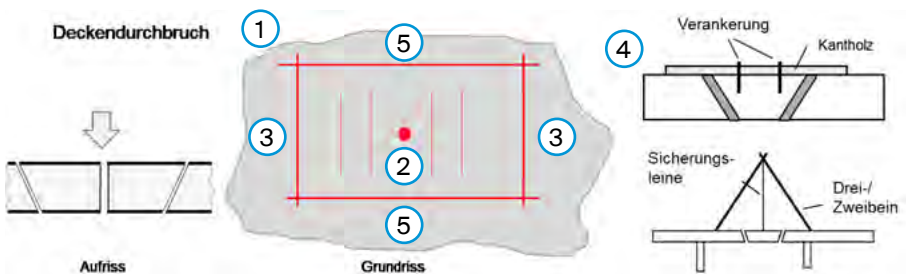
Deckendurchbruch mit Diamantwerkzeugen
